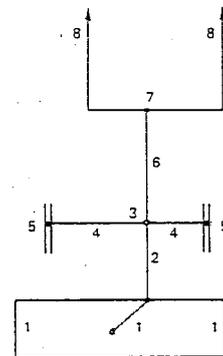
Installation de mise à la terre d'un bâtiment individuel
